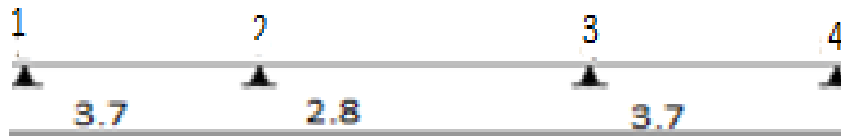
Schéma statique de la poutrelle à trois travées.
